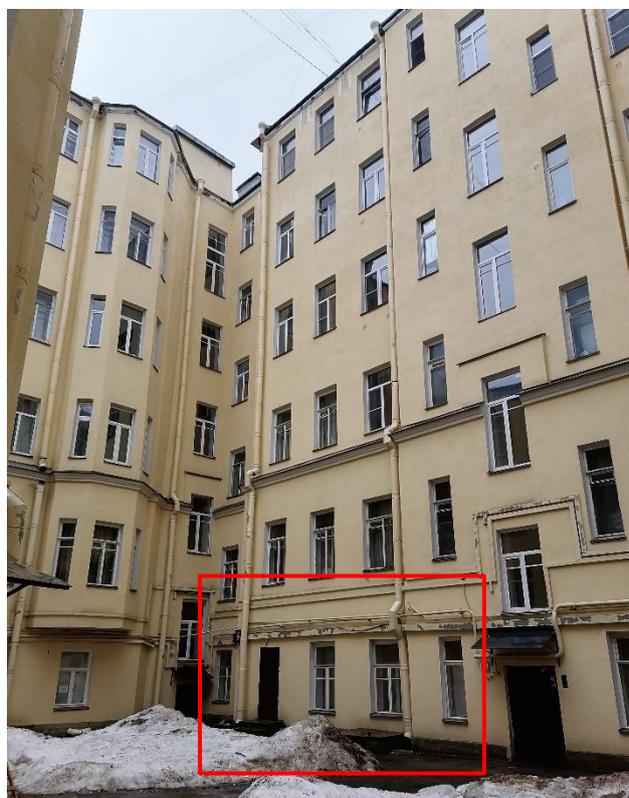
Дворовый фасад. Общий вид на юго-запад с указанием помещения 24-Н. 02.03.2022г.
